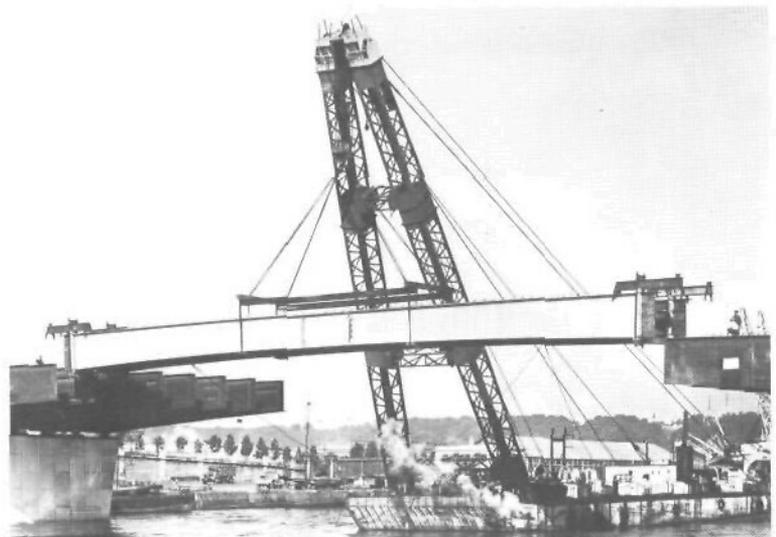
Demi-caisson de 57 mètres de longueur et 140 tonnes environ.
